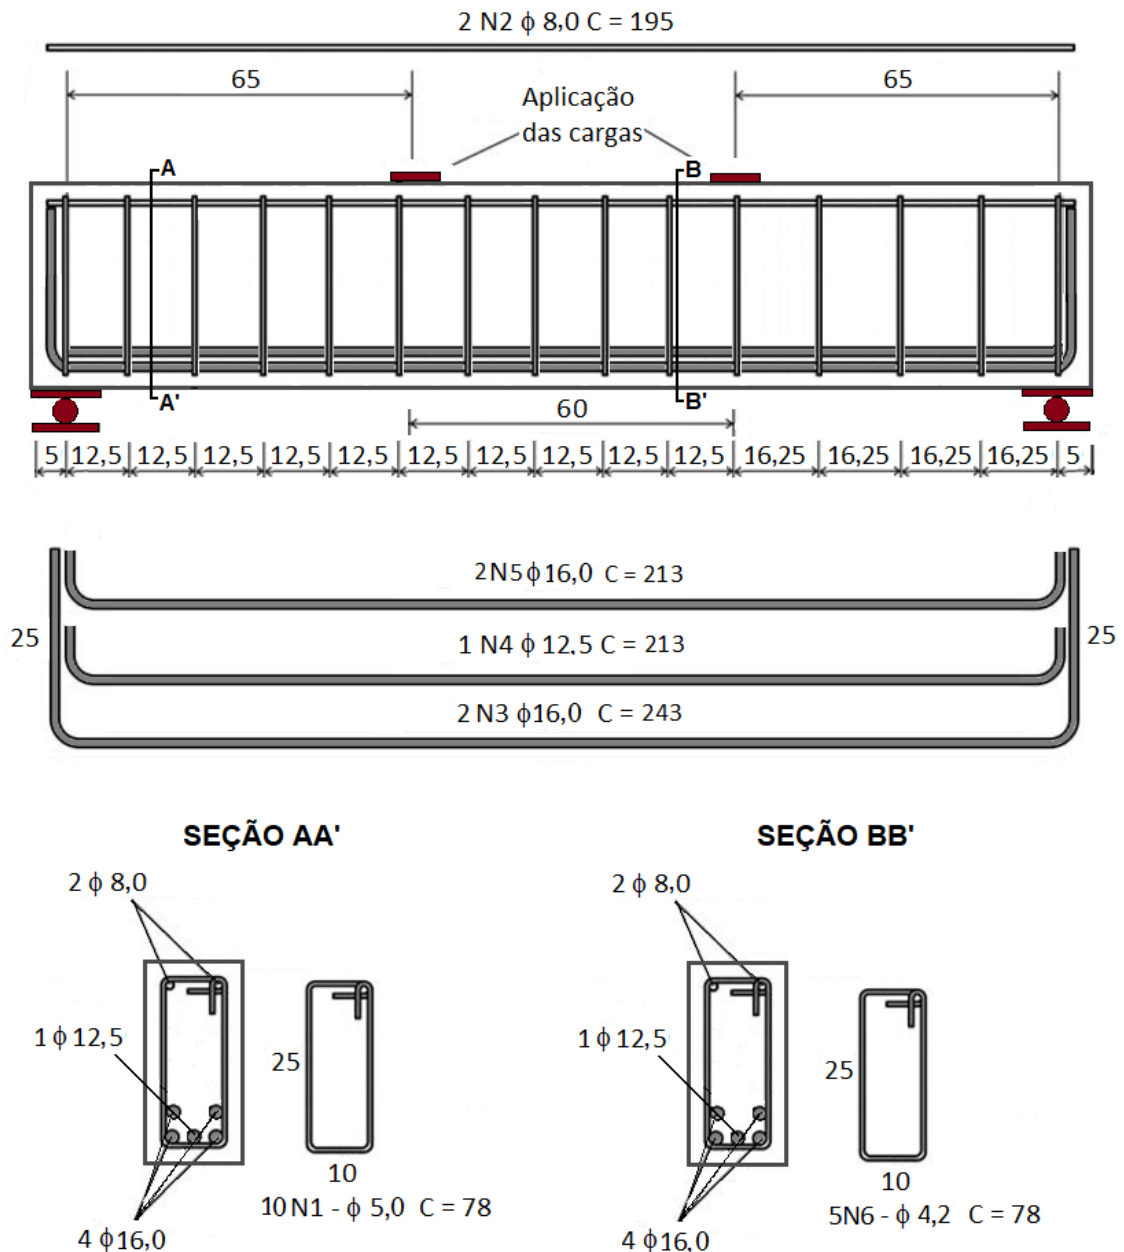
Armaduras das vigas do tipo 6 (dimensões em centímetros, exceto diâmetros que estão em milímetros).
